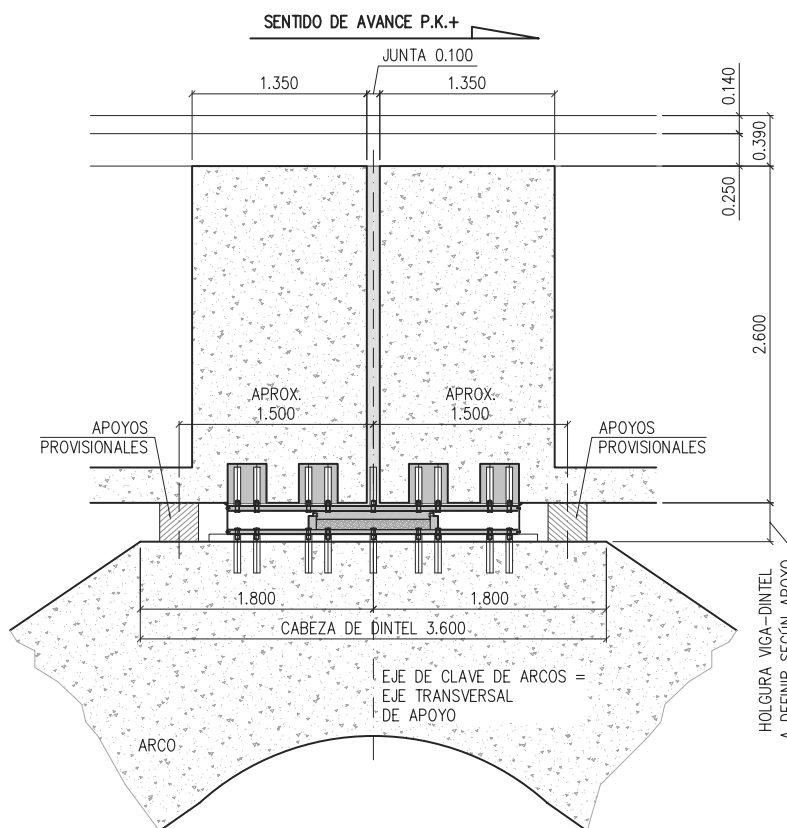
Puente con conexión a punto fijo intermedio. Detalle
